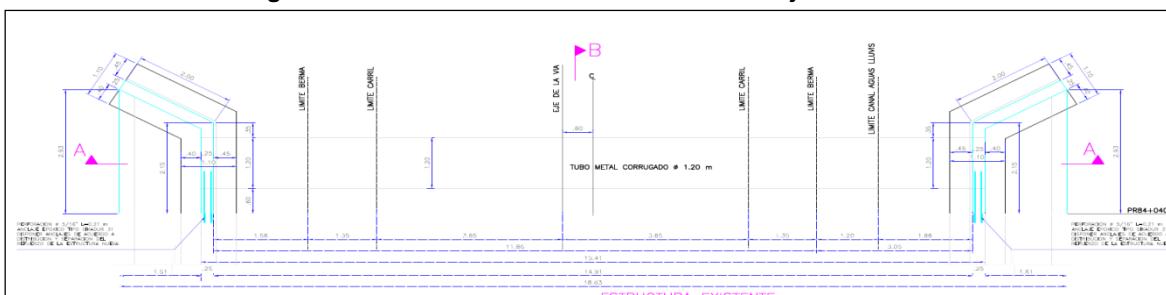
Planos de diseño de planta Box Culvert corte B-B para la obra de drenaje PR84+040
